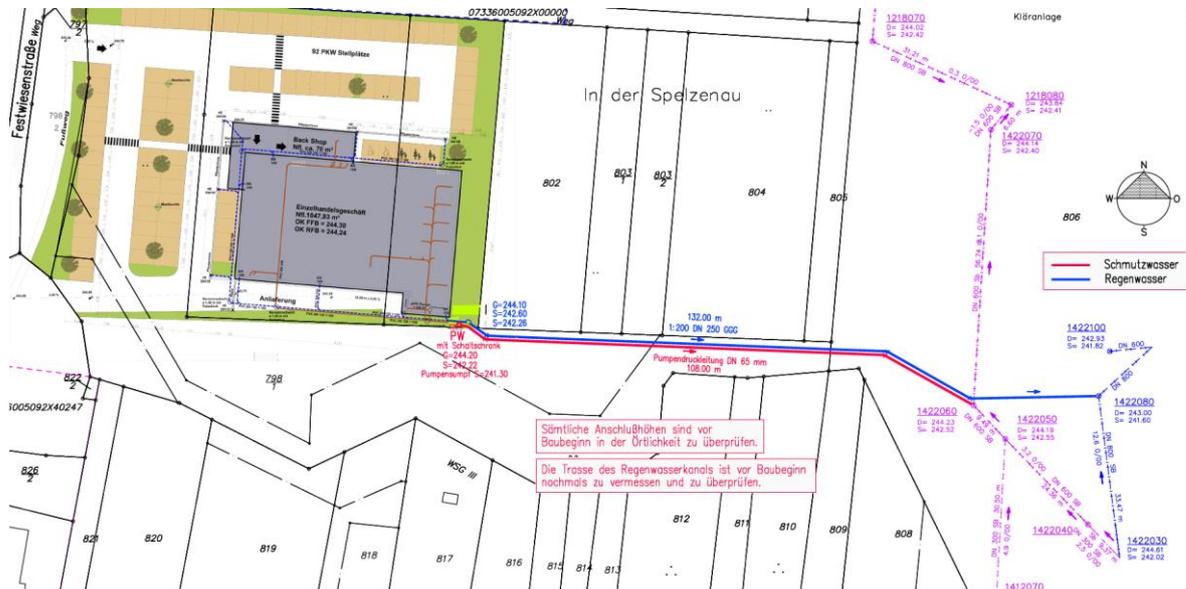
bestehende Entwässerungssituation, freier Maßstab
